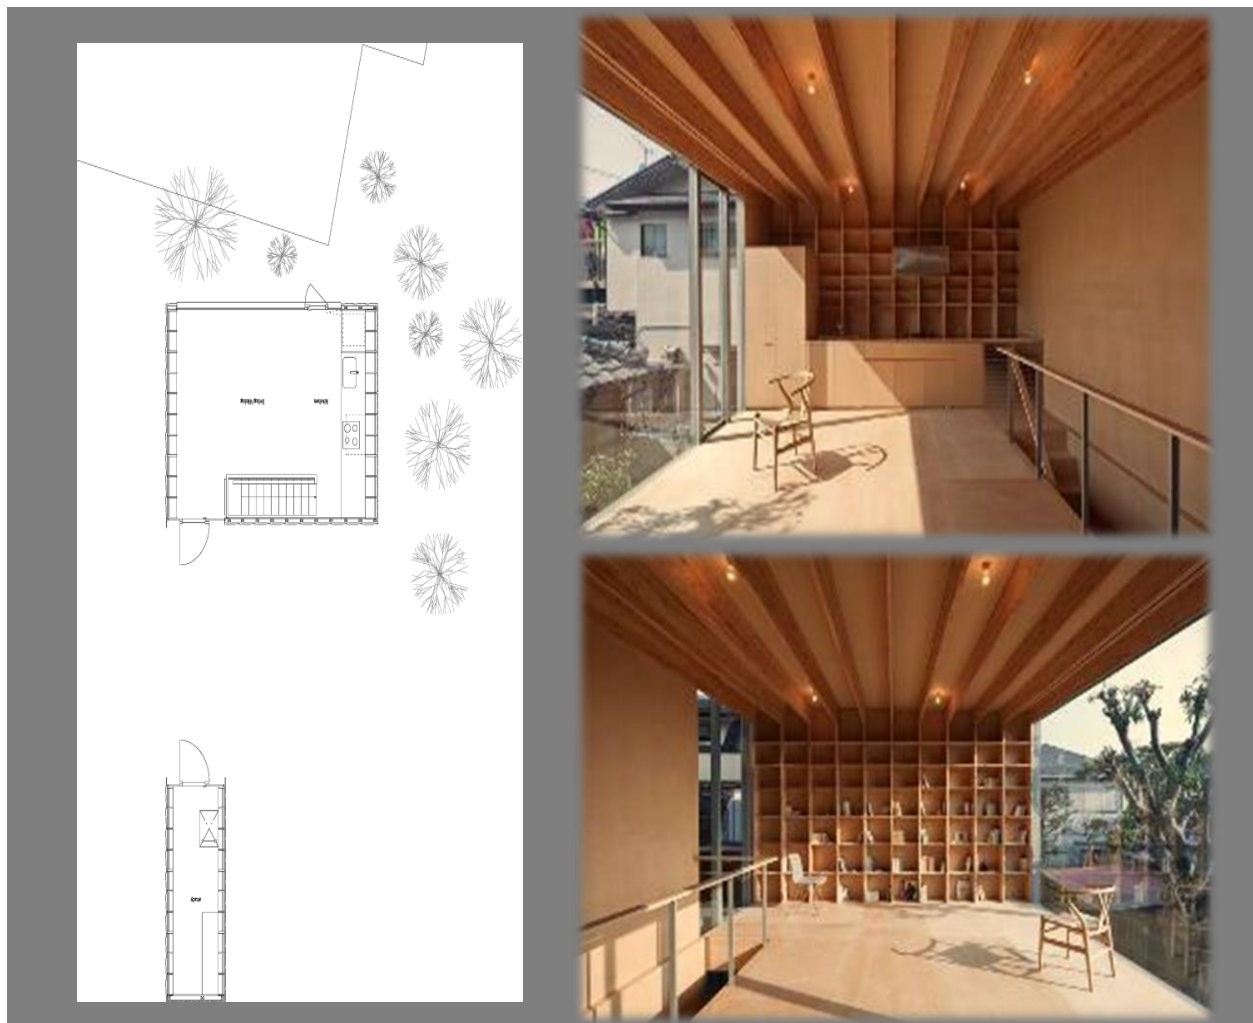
Planta arquitectónica y vista del interior del mobiliario habitable. Fuente: Revista digital *Designboom*. Accedido el 16 noviembre 2020.
